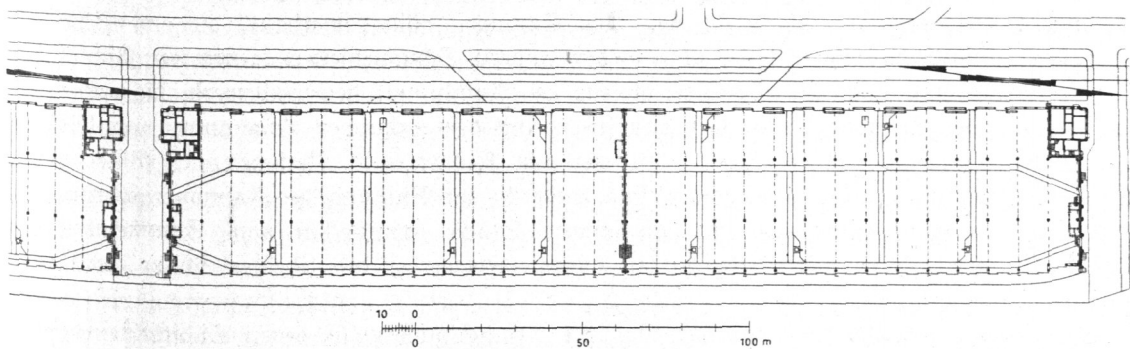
Kaischuppen 53 am Bremer Kai, Grundriß.
